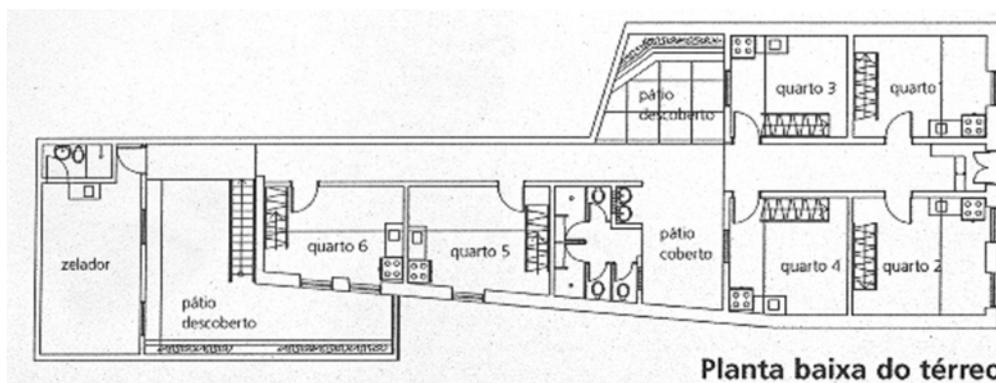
Planta do térreo – sem escala. PREFEITURA, 2003.
